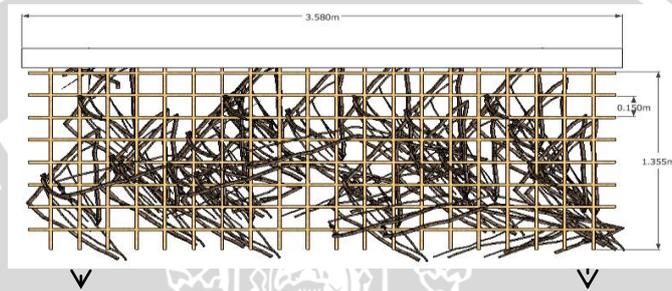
Tampak atas penerapan akar wangi sebagai ornamen plafon pada ruang *whirlpool
